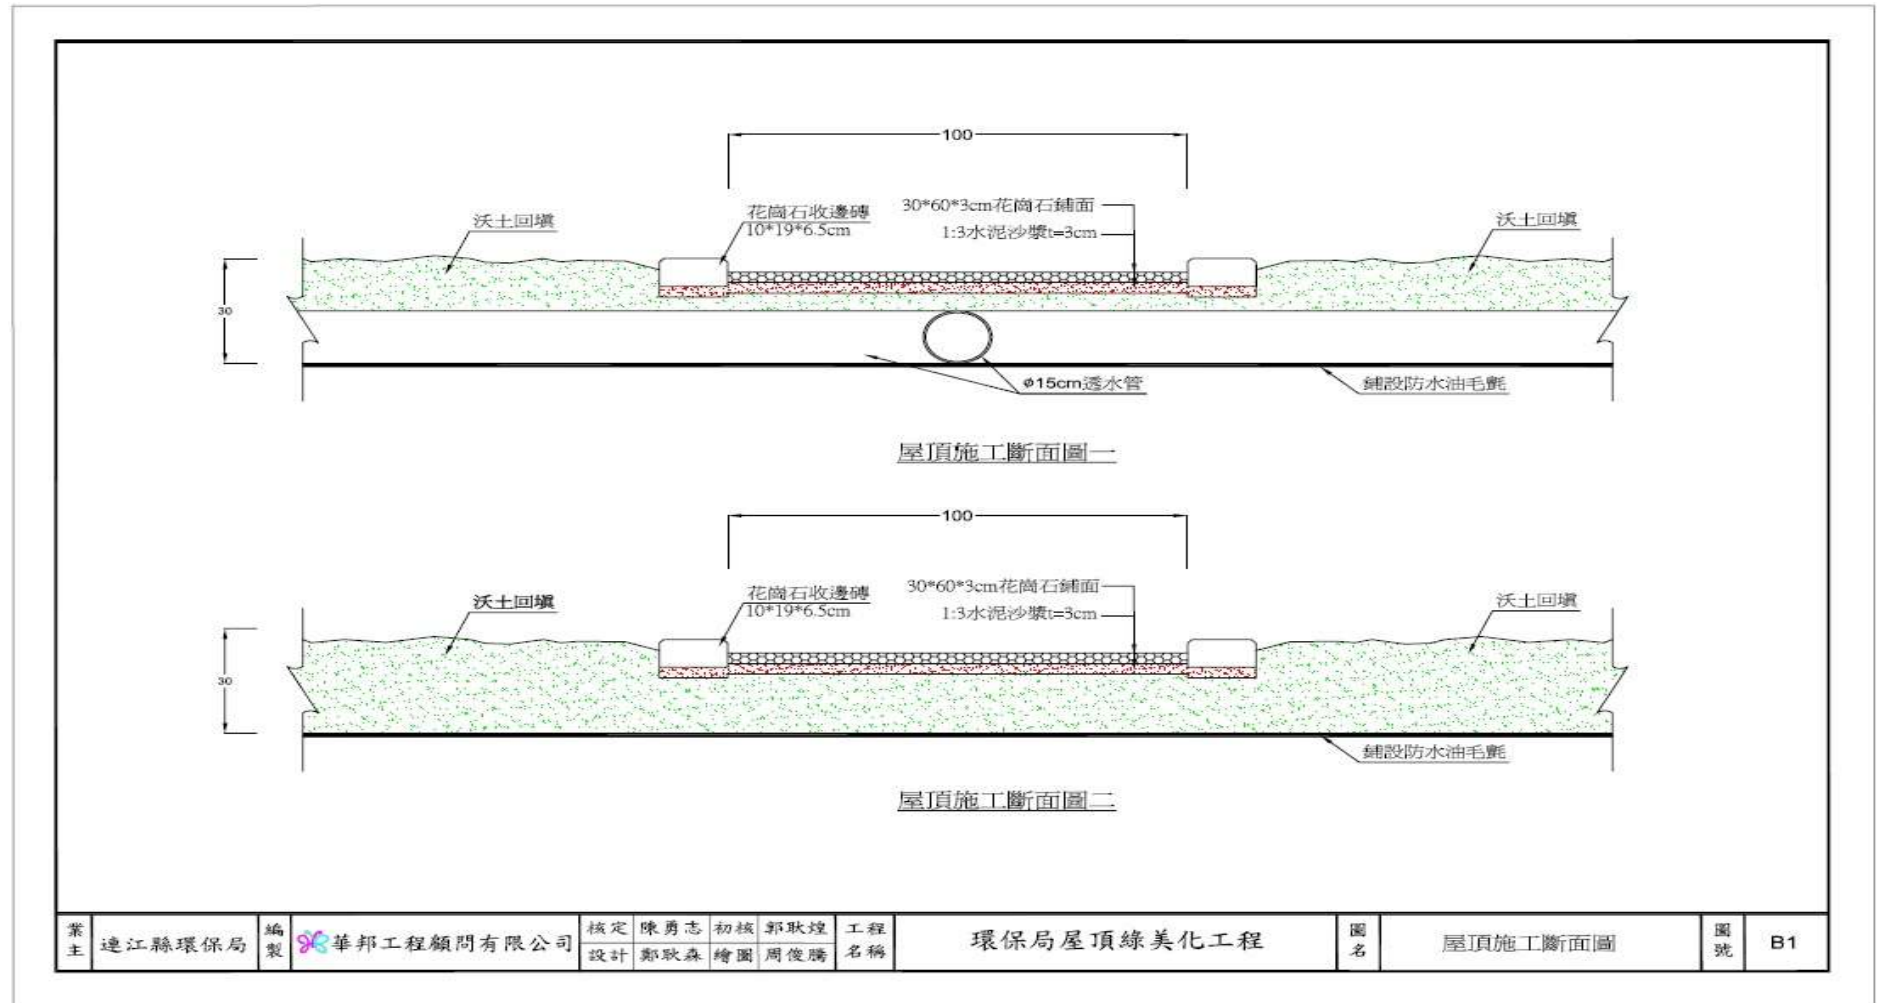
低碳環保觀光教育園區屋頂綠化改造示意圖-屋頂施工斷面圖
